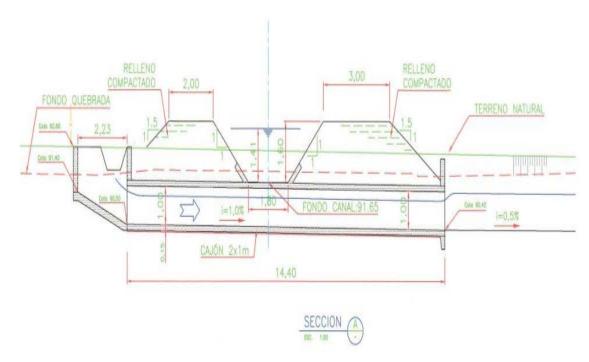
Sección transversal de cruce de quebrada bajo canal Lolol sur, en km 9+020
